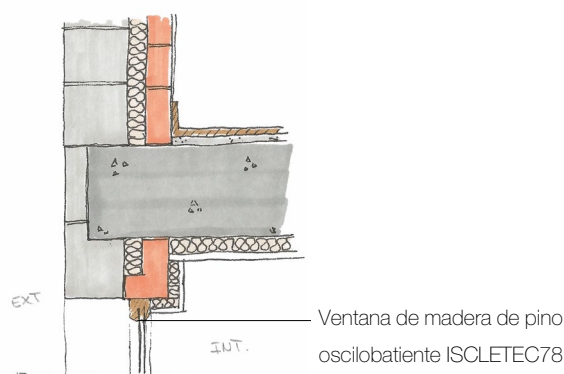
Detalle constructivo de parte superior del hueco de ventana con aislamiento por el interior (autoría propia).
